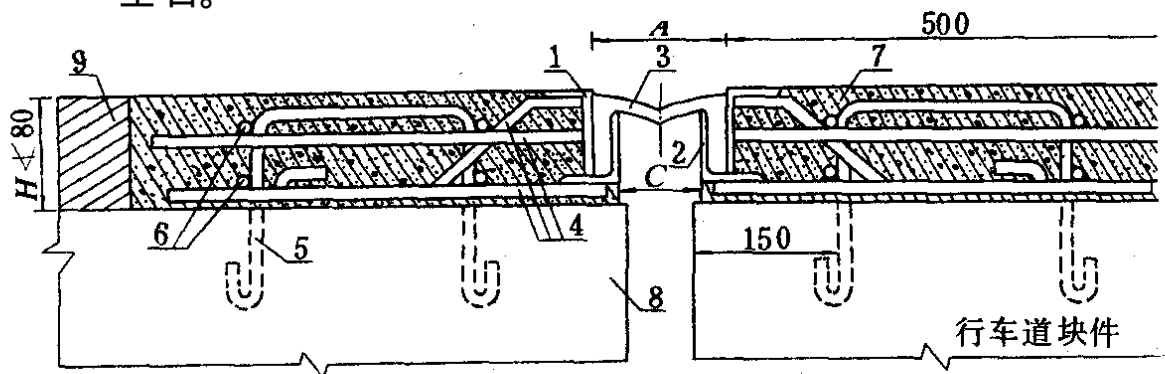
M 型橡胶伸缩装置构造示意图 (尺寸单位: mm)
